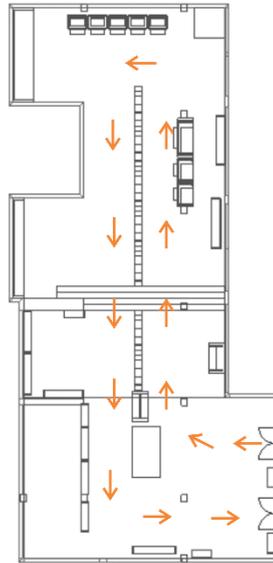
68 Layout Titik Lampu dan Signage Ruang Pamer I
